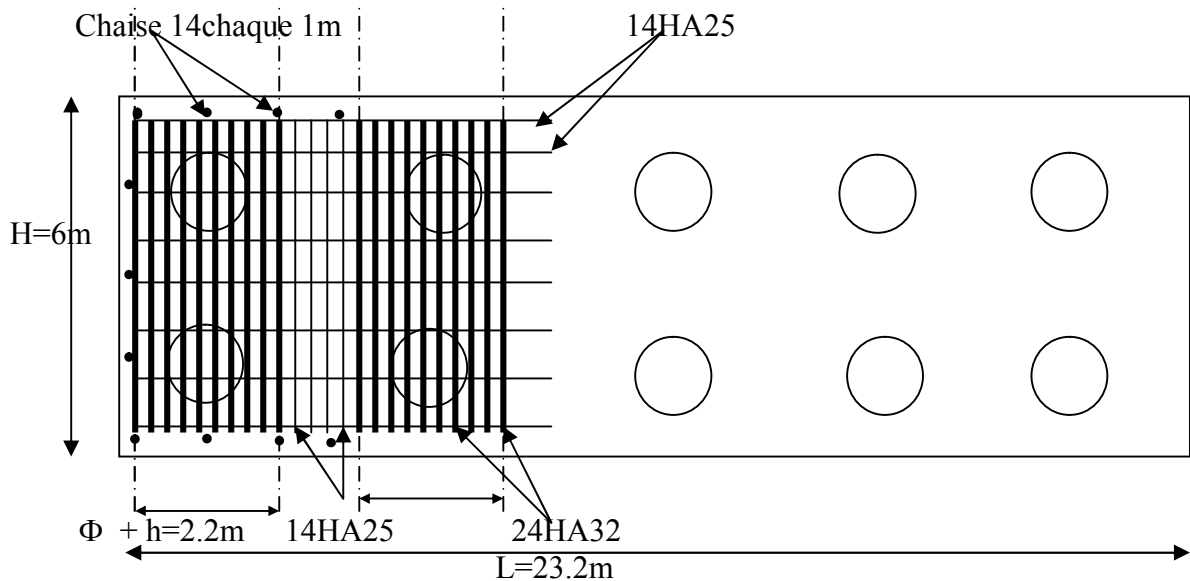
Ferrailage de la semelle (nappe inférieure)
